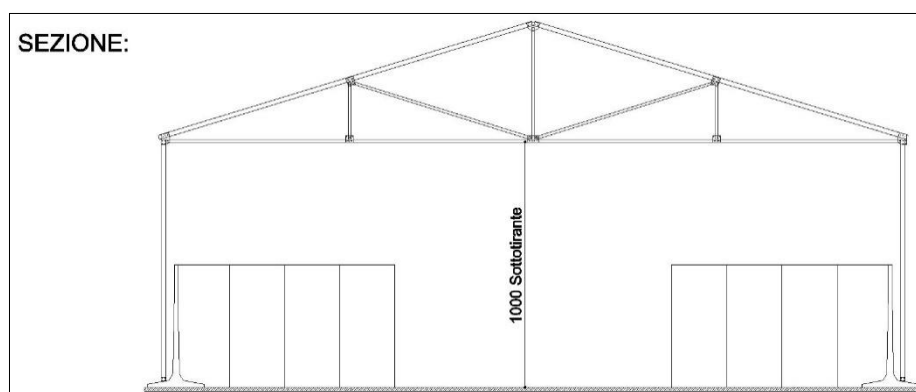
/B – Prospetto del fabbricato in progetto (non in scala).
